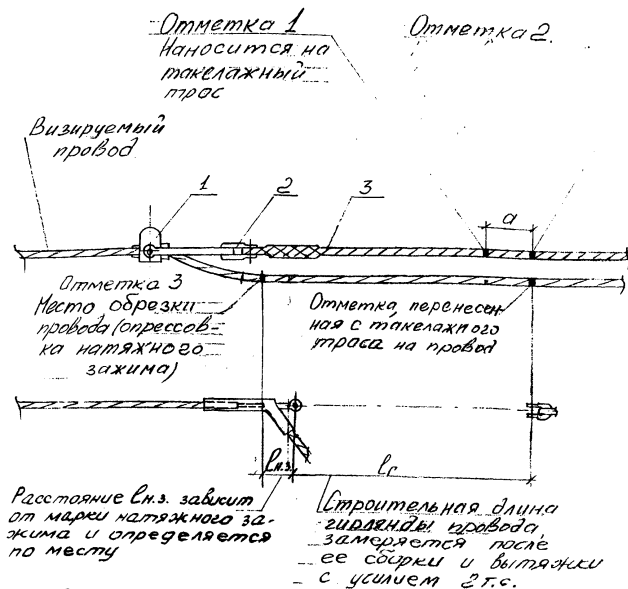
Схема переноса отметок с такелажного троса на провод.
